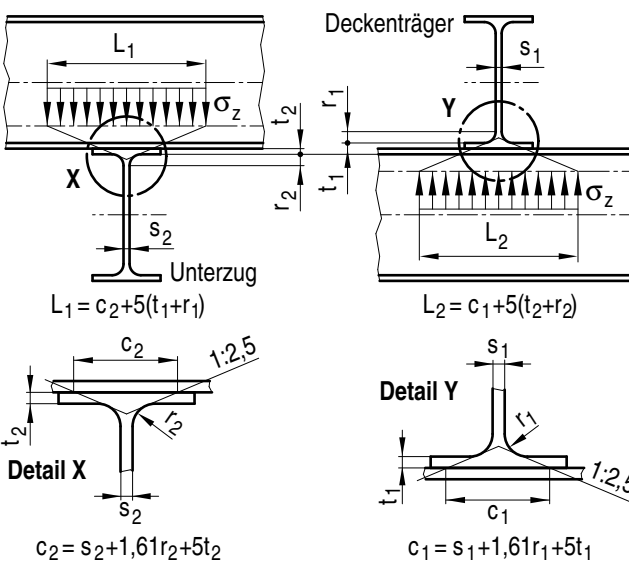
Steifenlose Lasteinleitung bei Walzprofilen mit H-Querschnitt (angelehnt an DIN 18800-1 historisch)
